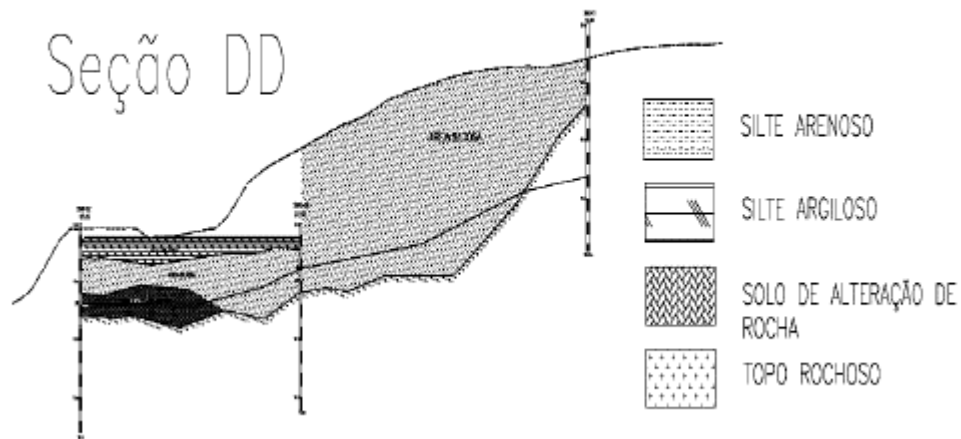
Perfil Geotécnico definido pelas Sondagens Mistas – Seção “DD”
